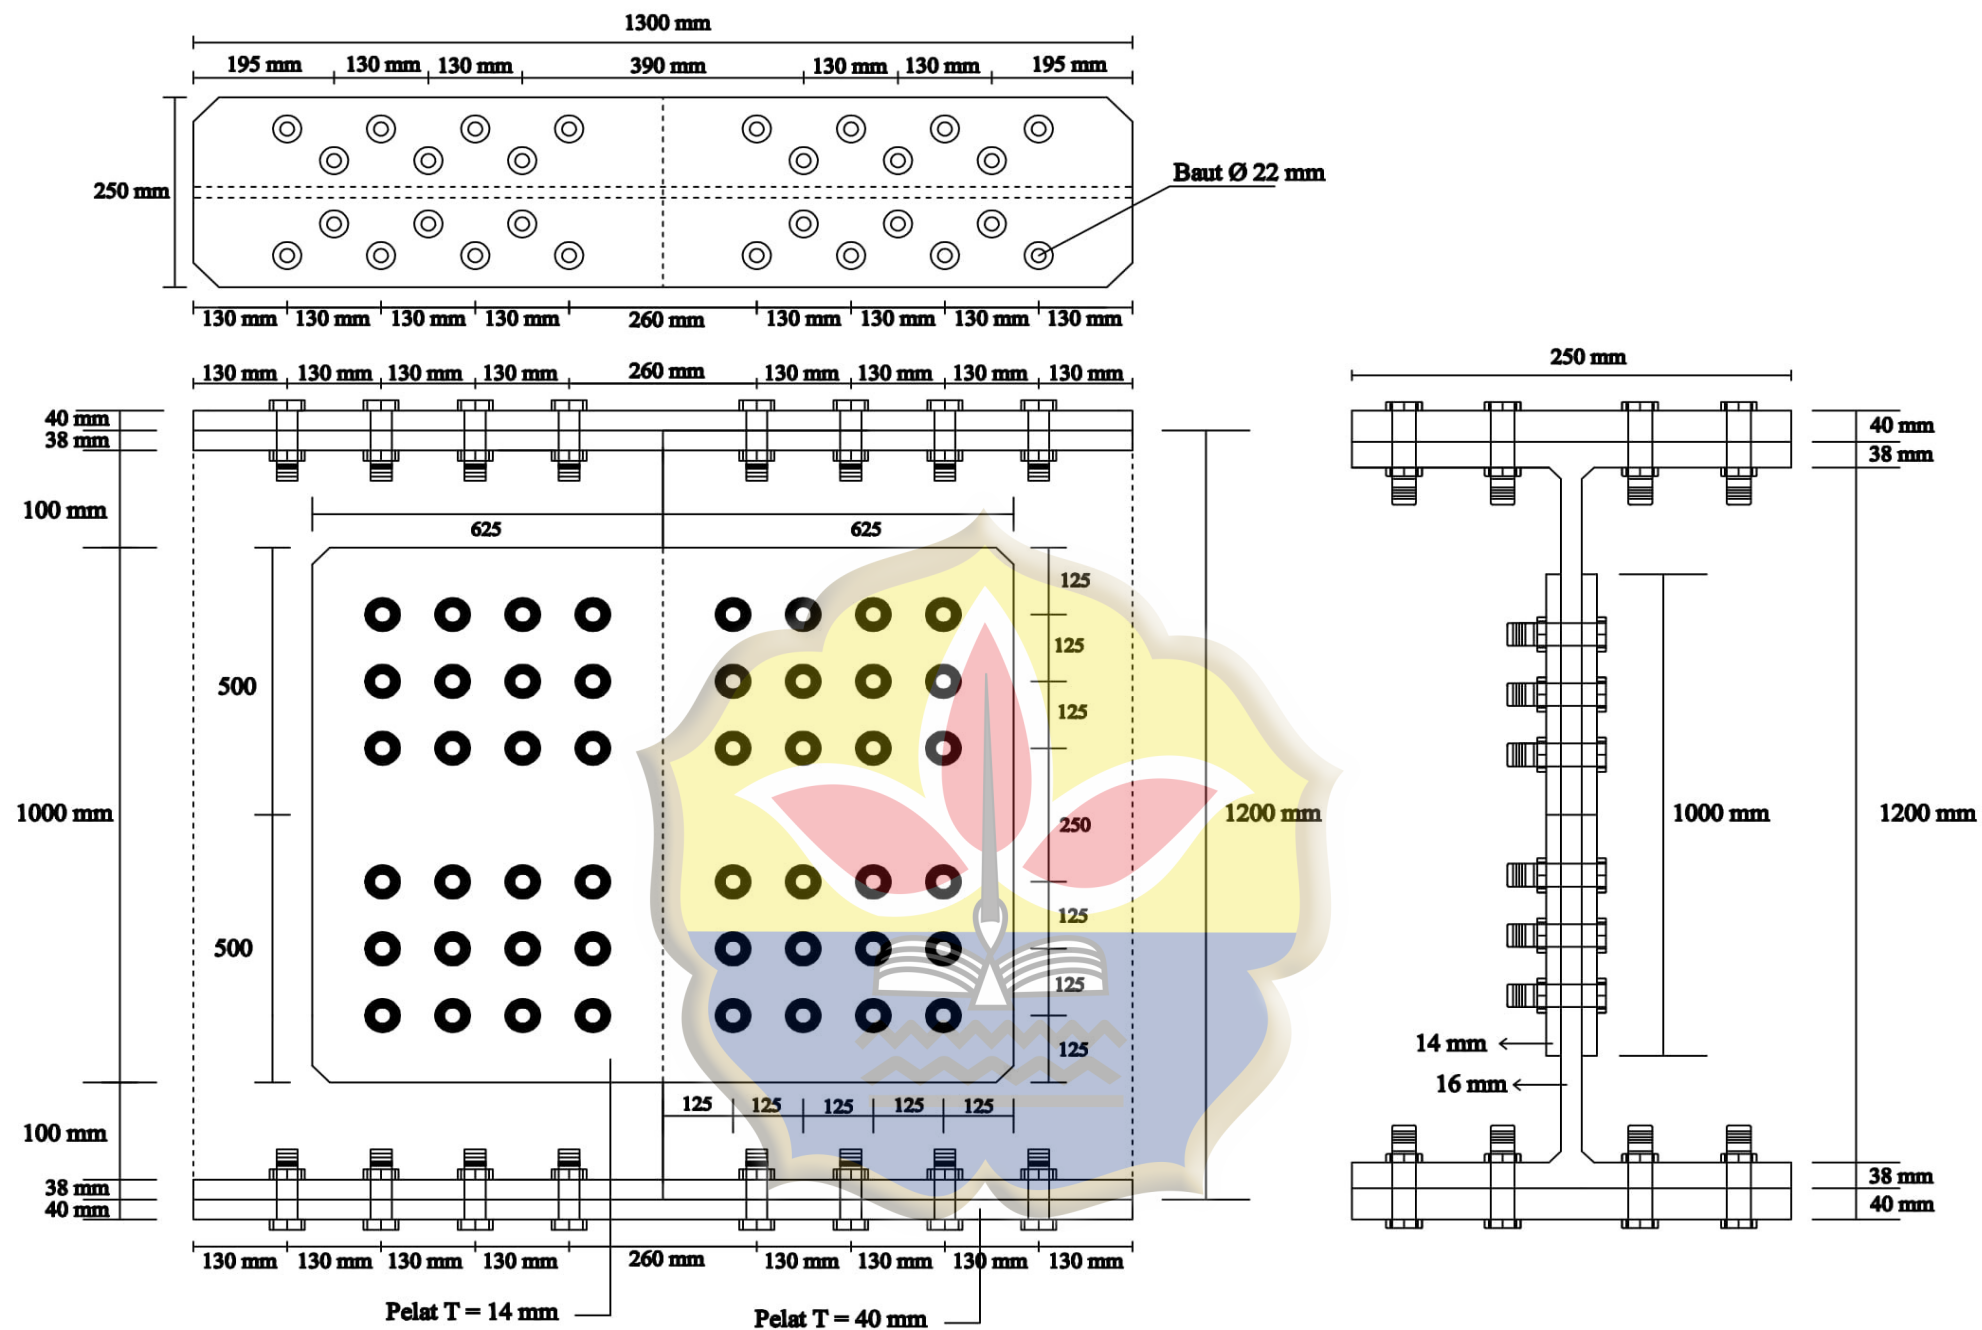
DETAIL SHEAR CONNECTOR TAMPAK ATAS
